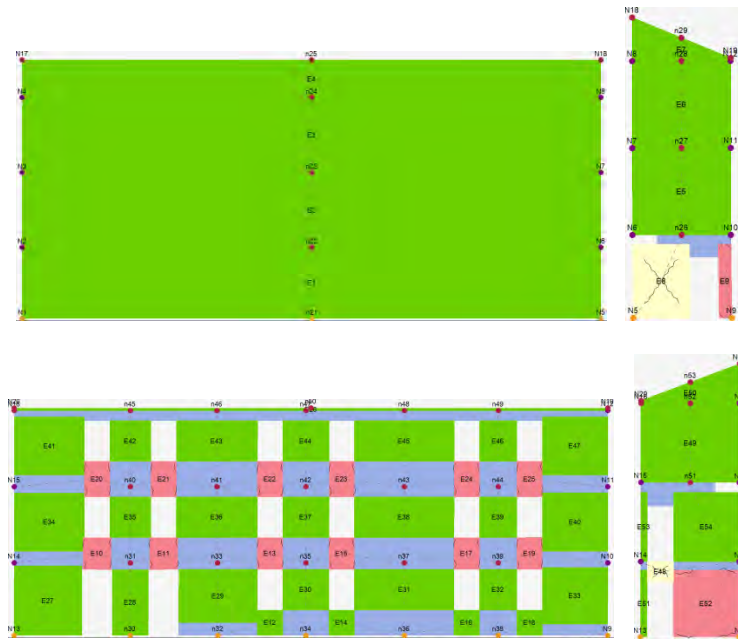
Rappresentazione delle pareti, rispettivamente da in alto a sinistra: parete 1, parete 2, parete 3 e parete 4.
